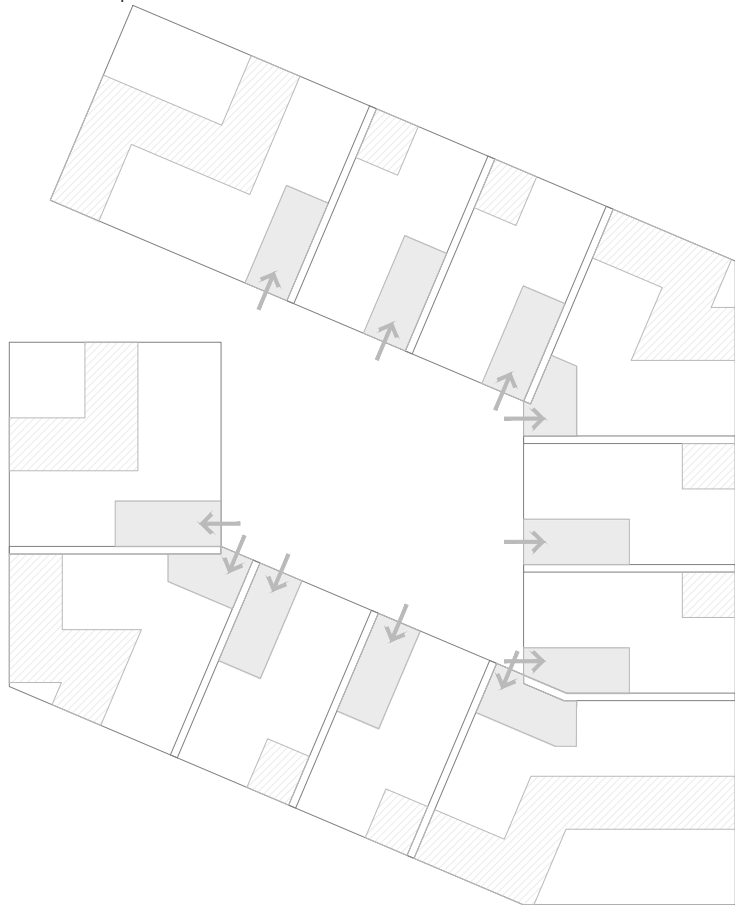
Planta esquemático pátios de acesso e pátios transição para a rua
